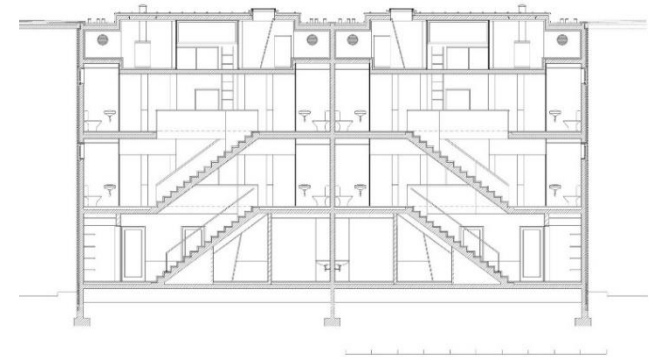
Corte trasversal del edificio, FUENTE: Arch Daily
